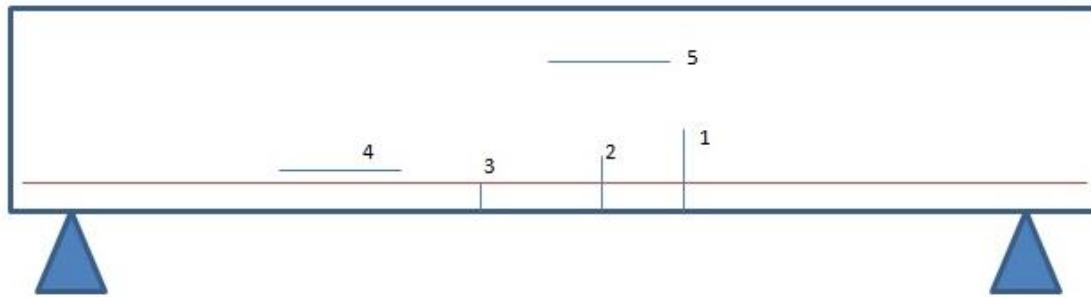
Grietas en elementos sometidos a flexión. *Fuente:* Elaboración propia.
